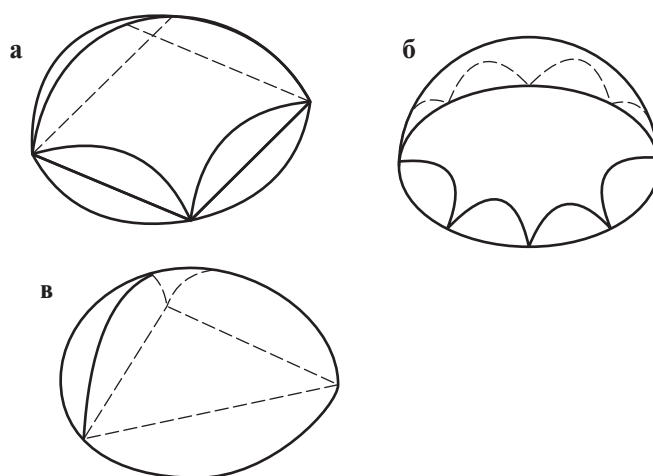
Сетчатые оболочки положительной гауссовой кривизны: а) на треугольном плане; б) на квадратном плане; в) на многоугольном плане
